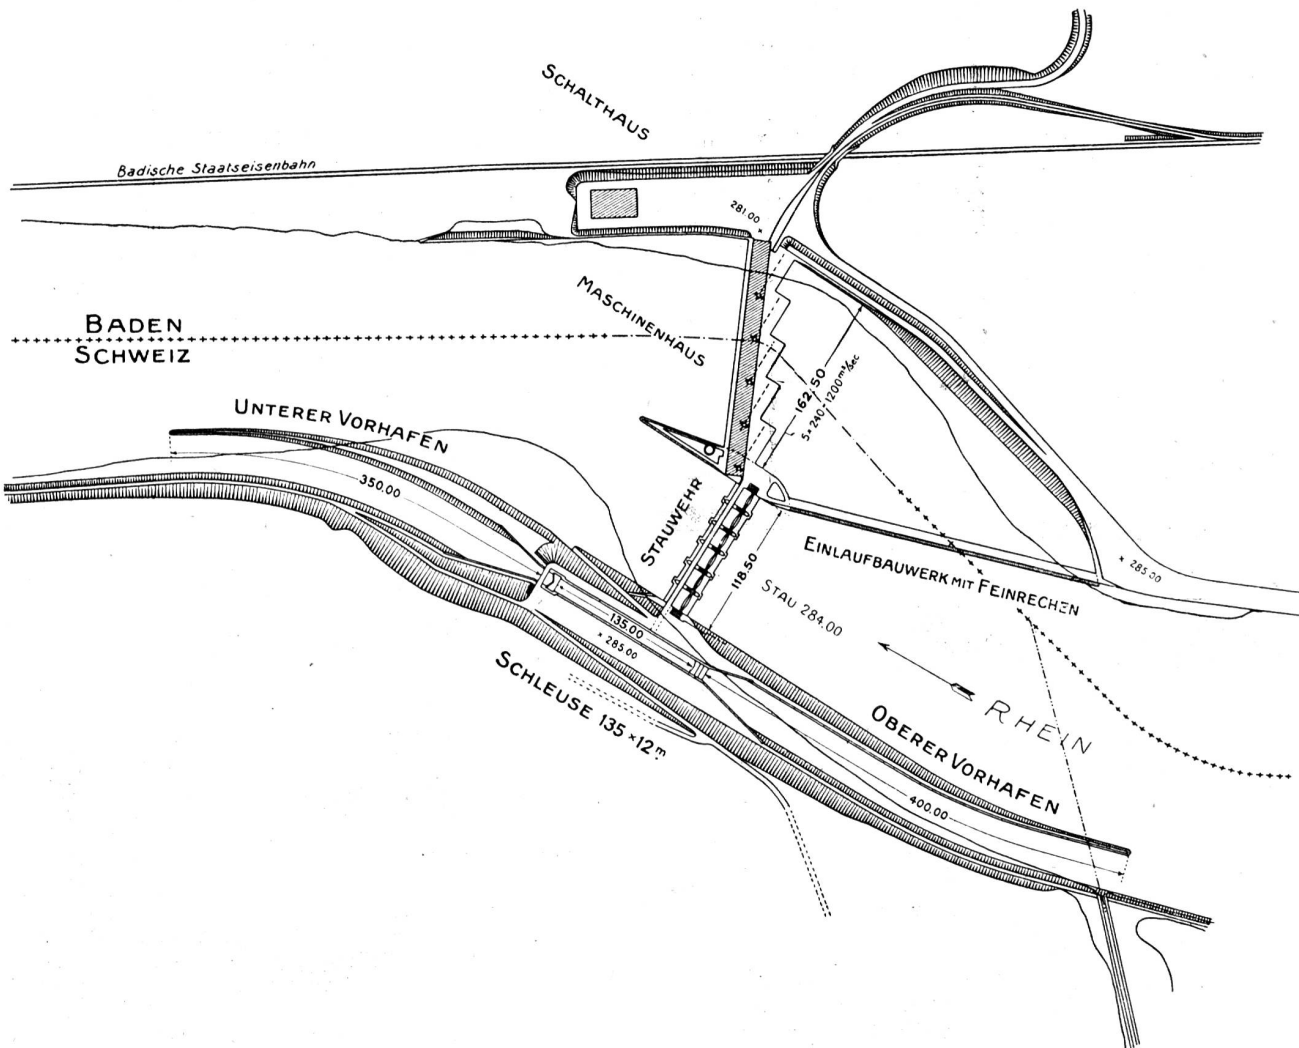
Projektiertes Kraftwerk Schwörstadt. Übersichtsplan der Stauanlage. Maßstab 1 : 600.
